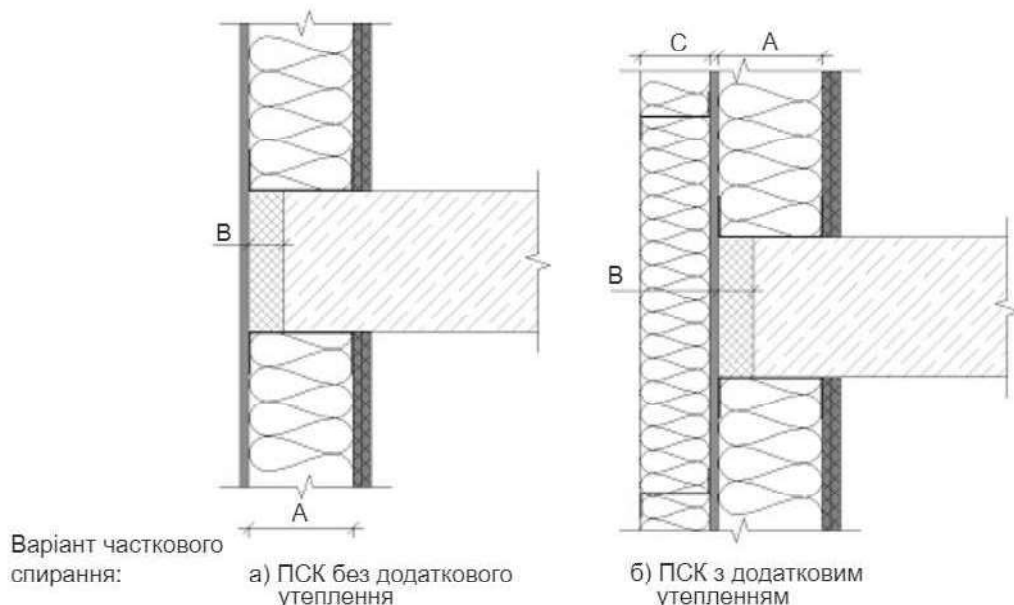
Схеми вузлів спірання ПСК на залізобетонні плити перекриття
